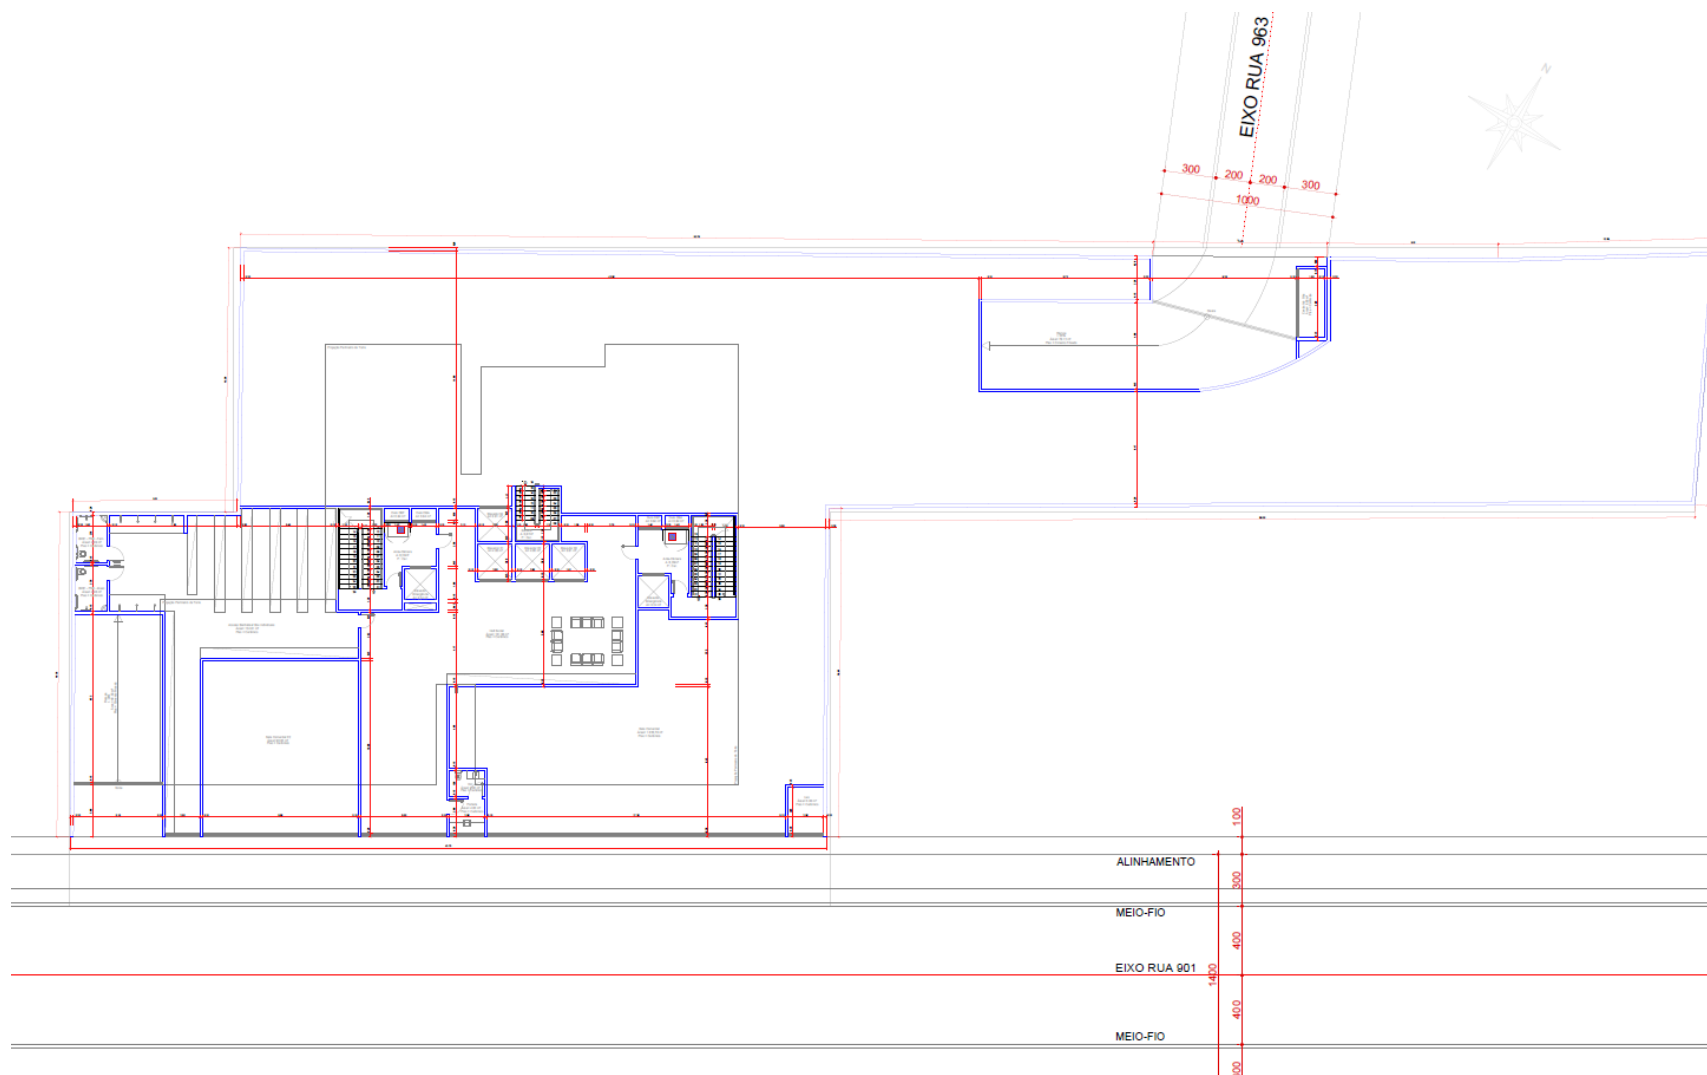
Planta Baixa - 1º Pavimento Térreo. Área: 2.041,03m² - Área: 2.041,03m² - Área: 2.063,10m².
